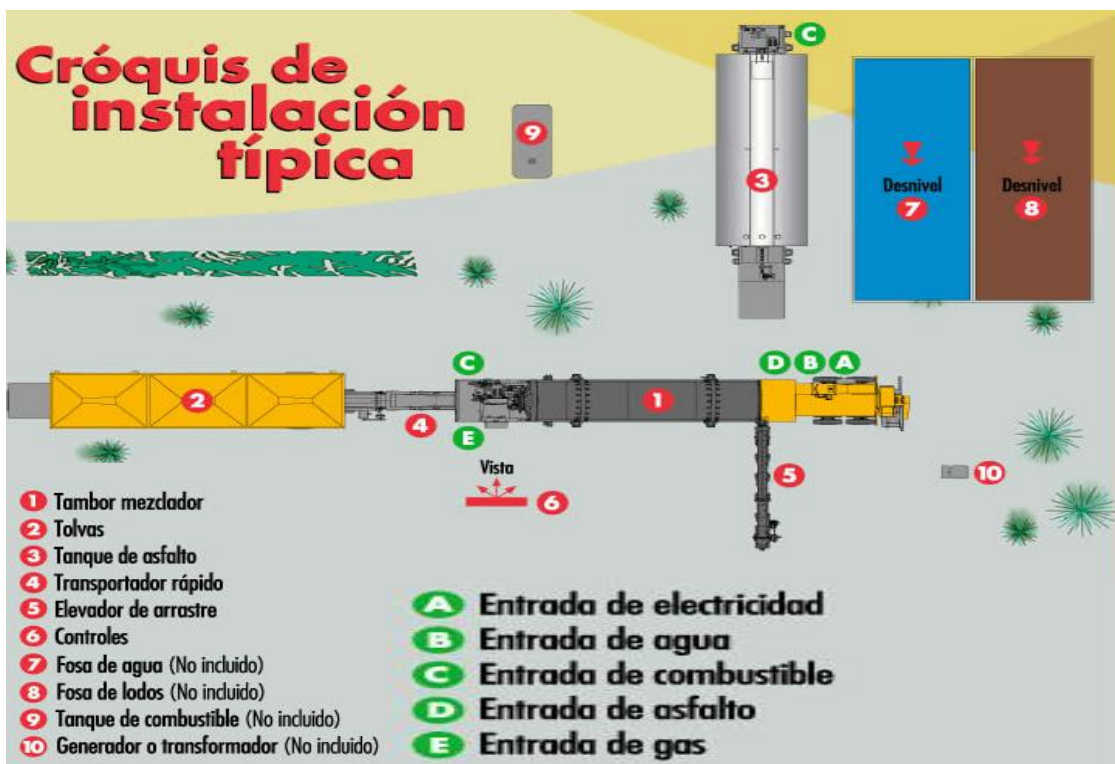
17.- Croquis de instalación típica de una planta de asfalto.
